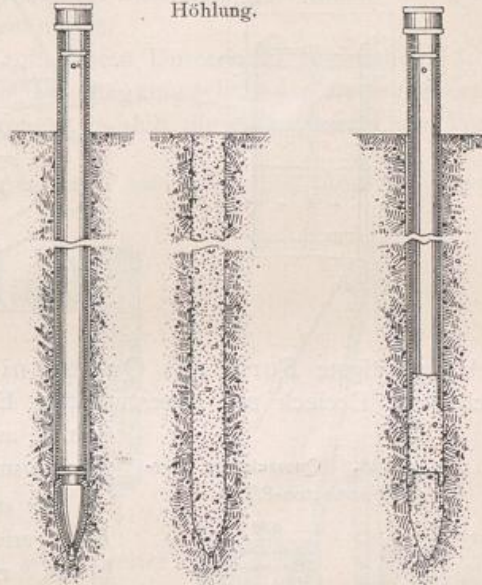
Herstellung eines Beton-Stampfpfahls in weichem Boden.
